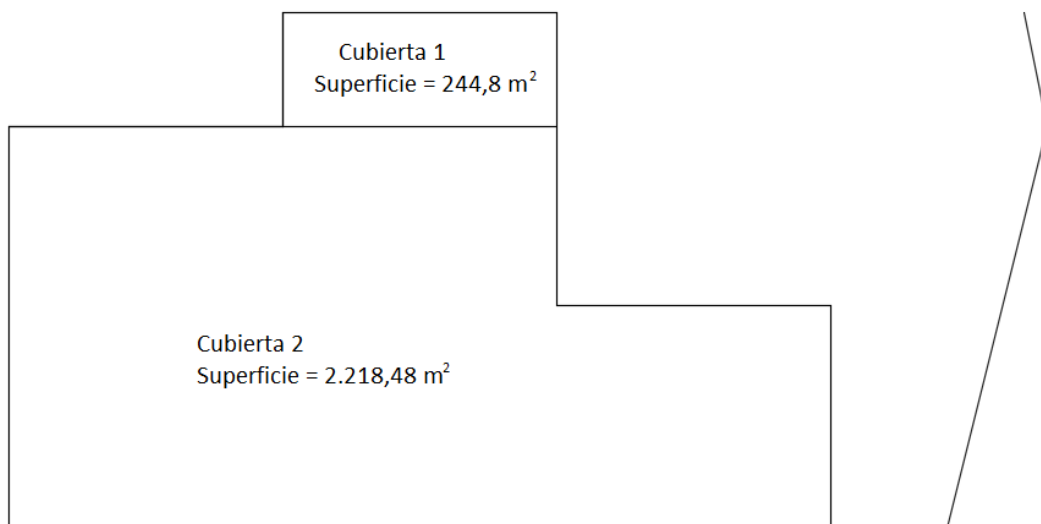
Planta y perfil de la cubierta con superficies. Fuente: propia
